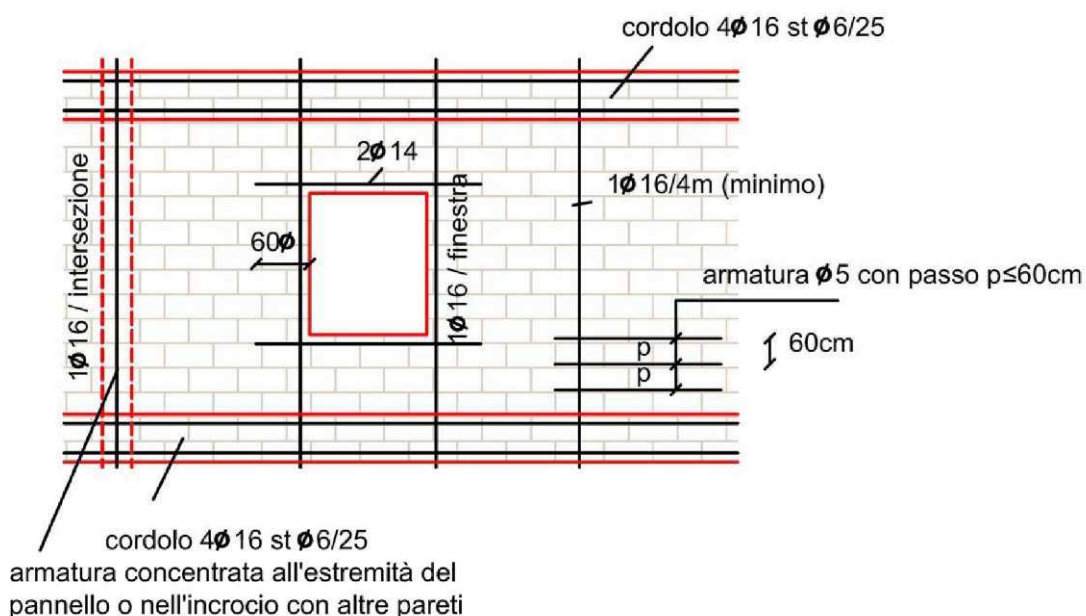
Disposizione delle armature per una parete in muratura
